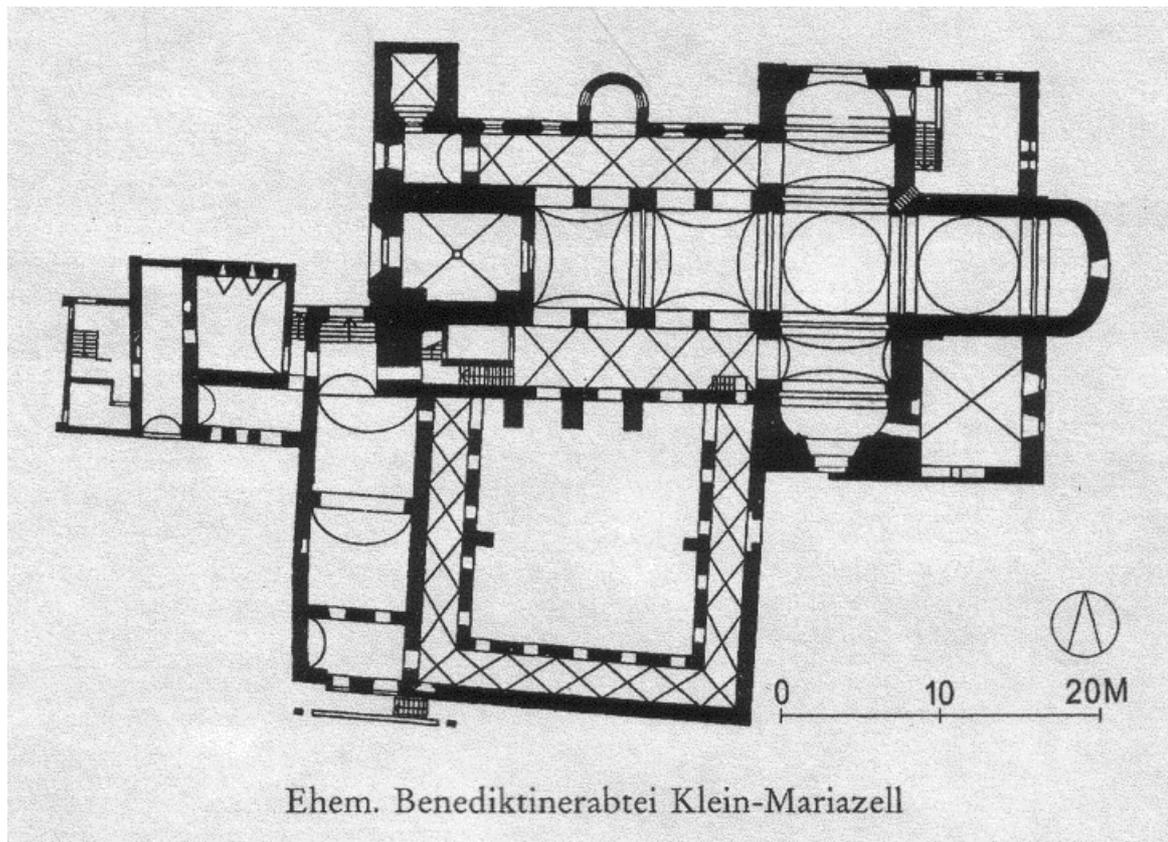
Klein-Mariazell, Ehemaliges Benediktinerstift Klein-Mariazell, Grundriss
